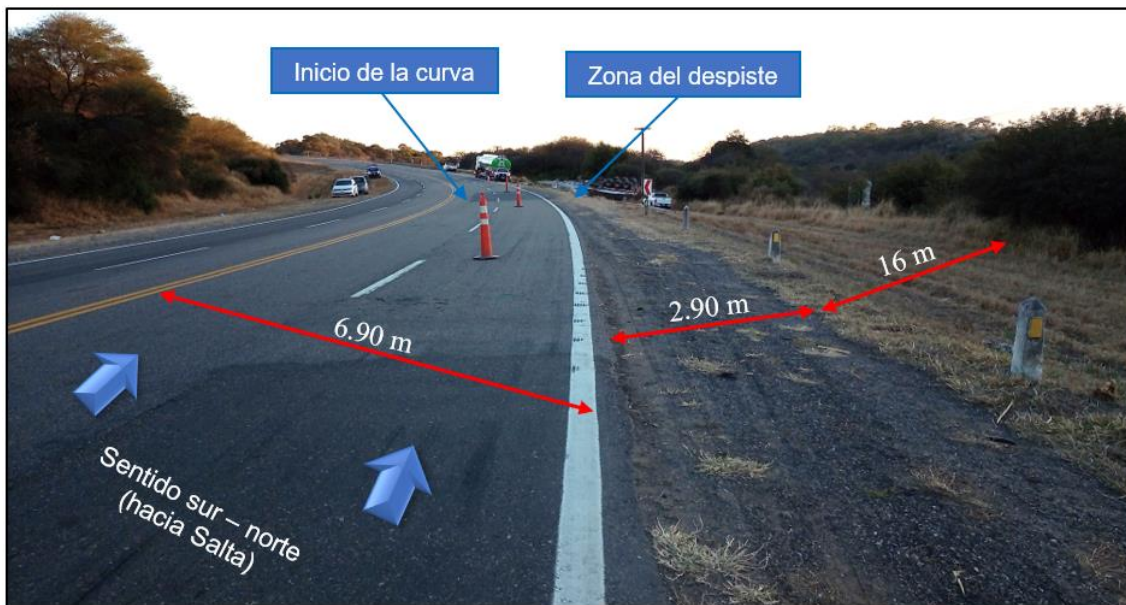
Dimensiones de calzada, banquina y zona de préstamo de progresiva sur-norte, por la que transitaba el camión. Fuente: JST.
